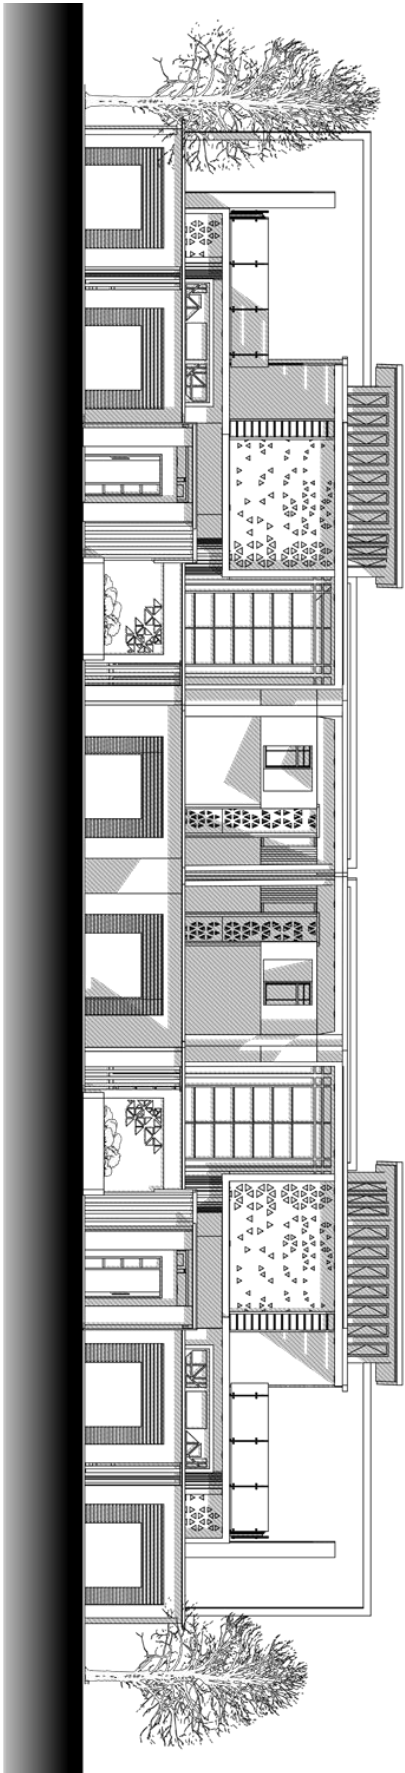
Façade principale avec clôture (F5/F5), ech 1/100.
